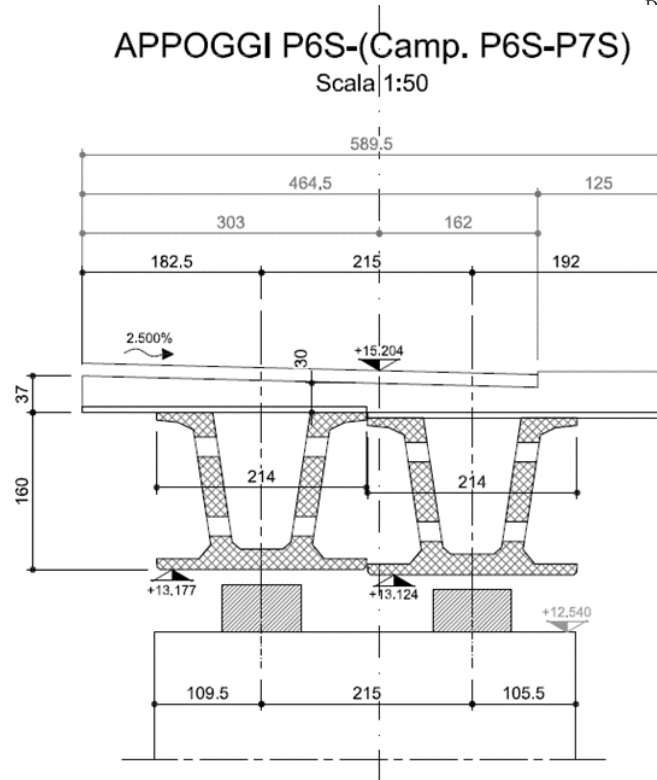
Sezione trasversale su P6S – Rampa S
